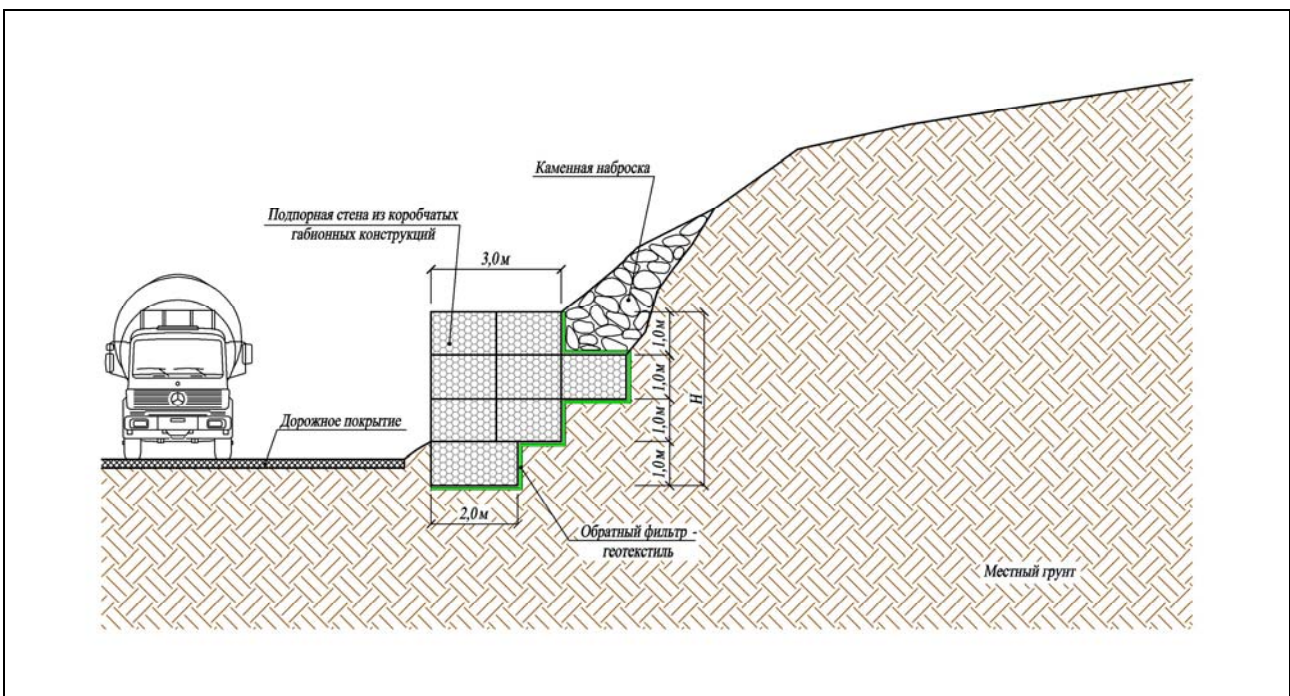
Схема подпорно-удерживающего сооружения срочного вмешательства из коробчатых габрионных конструкций
